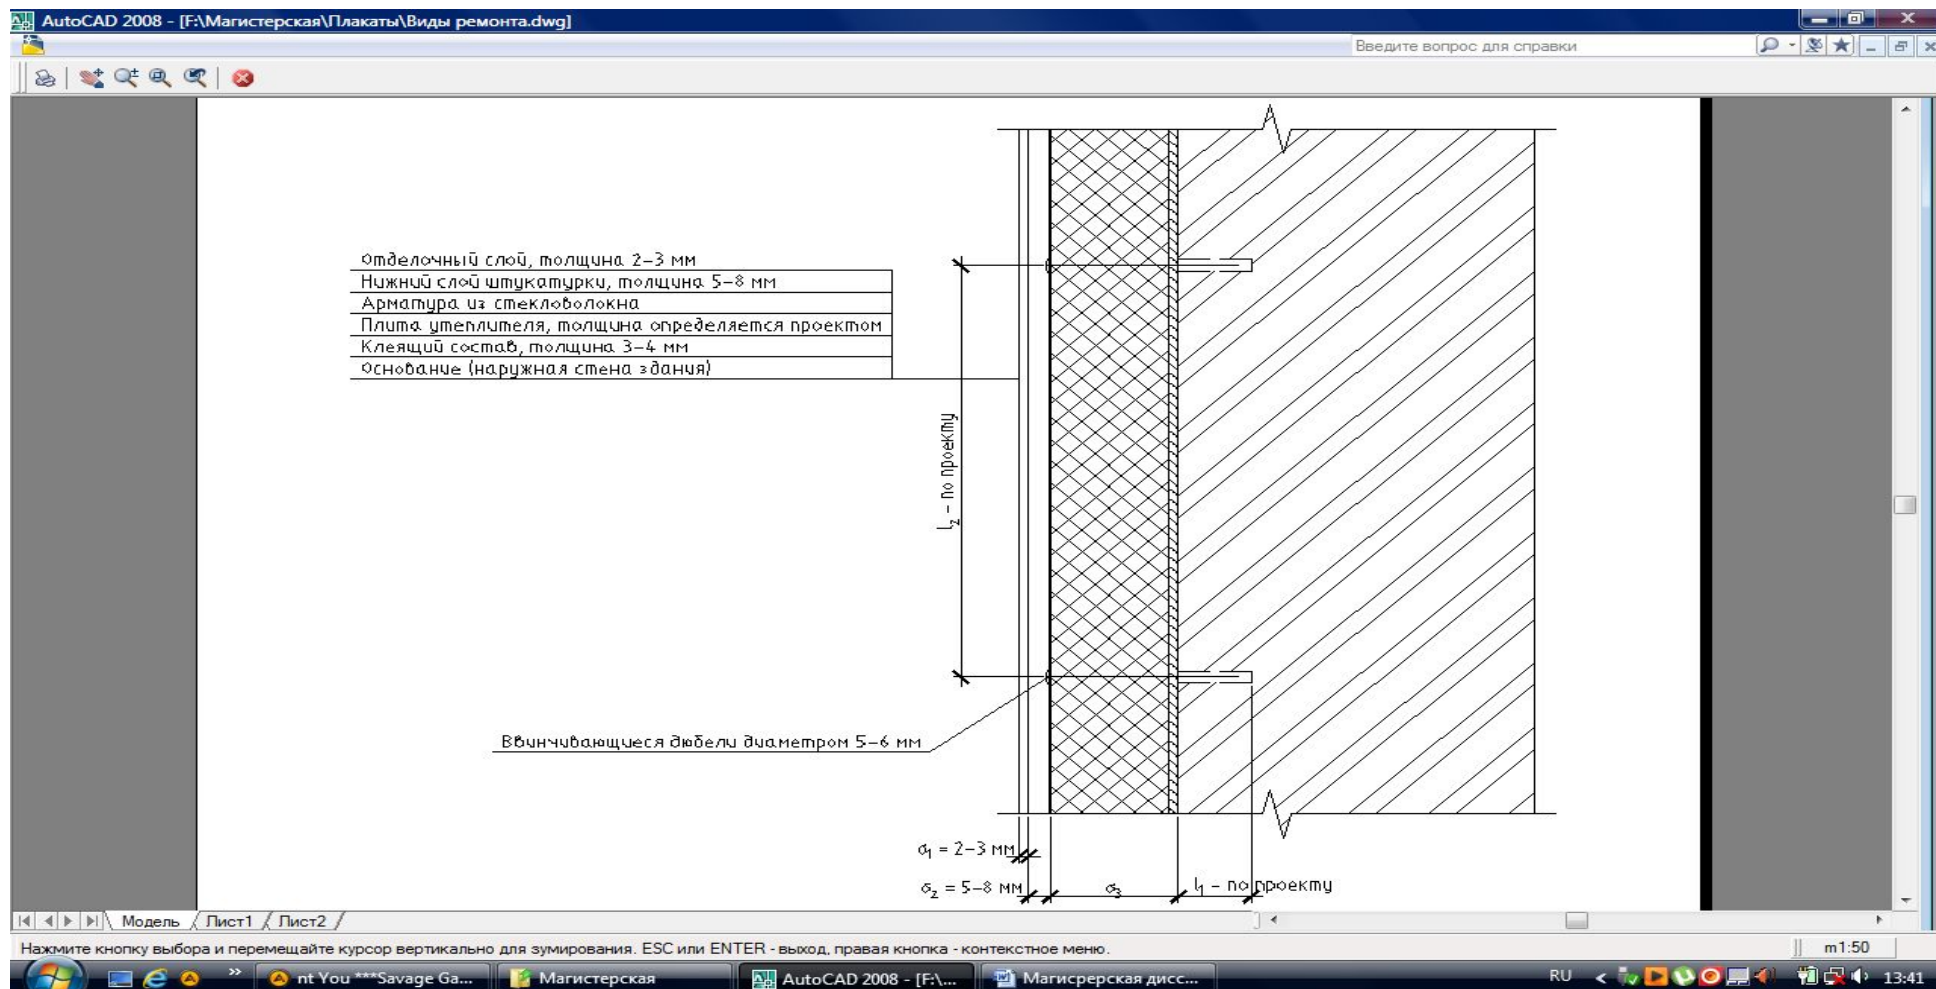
Фрагмент наружной теплоизоляции здания с тонкой штукатуркой по утеплителю.
